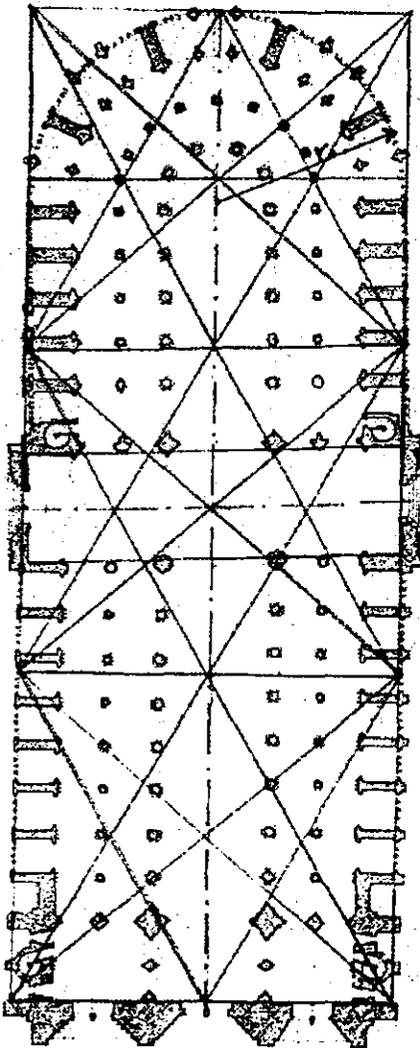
Trazo de la Planta de la Catedral de Notre Dame de París.
